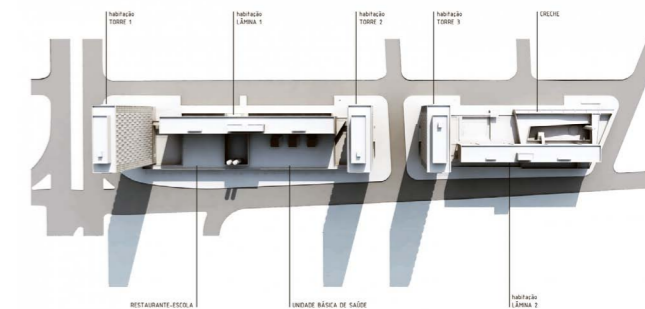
Implantação do conjunto. Fonte: MMBB.
